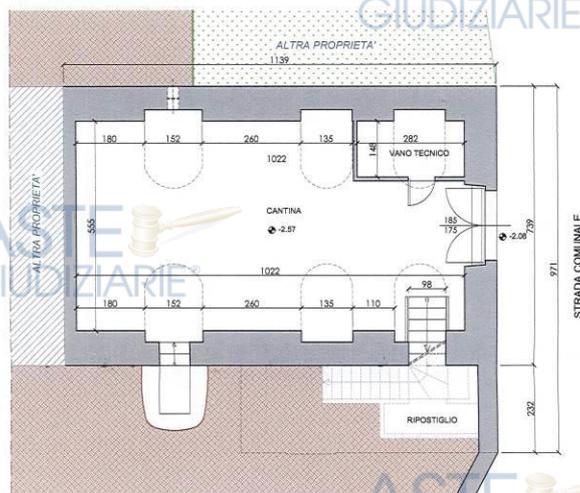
Estratto Dia n.77/49 del 2012 pianta piano interrato
